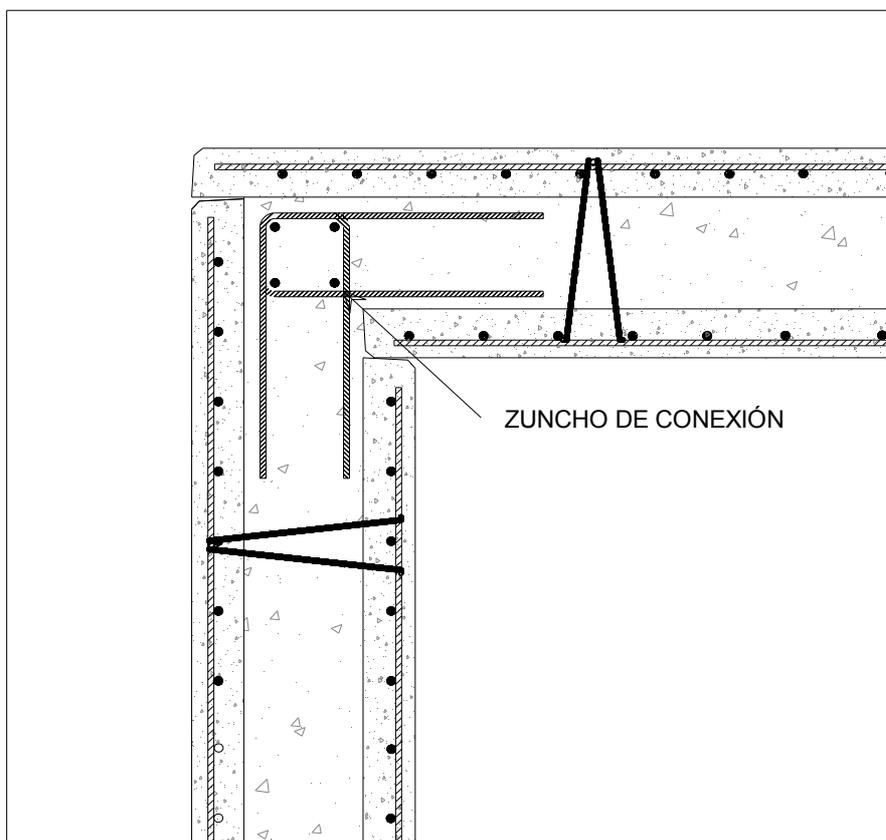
DETALLE DE UNIÓN EN "T" (planta)
